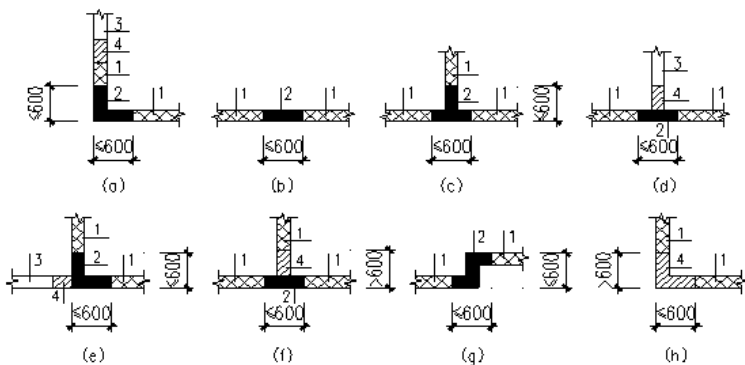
预制剪力墙间可计入预制混凝土体积的现浇段示意图
